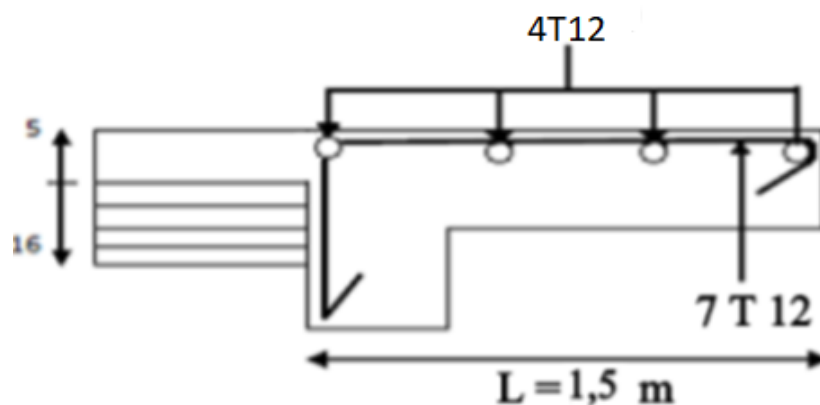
Dessin de ferrailage de la dalle pleine.
